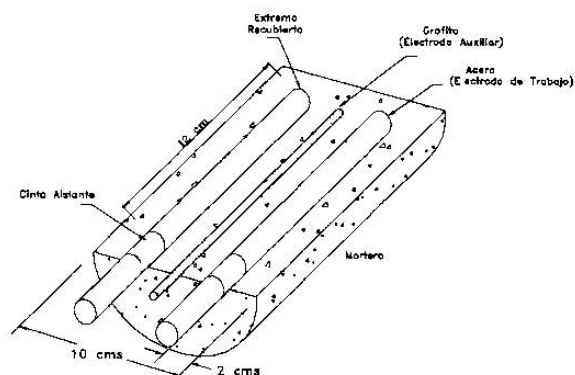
Disposición de las barras de acero dentro de la probeta de mortero. Corte longitudinal.
